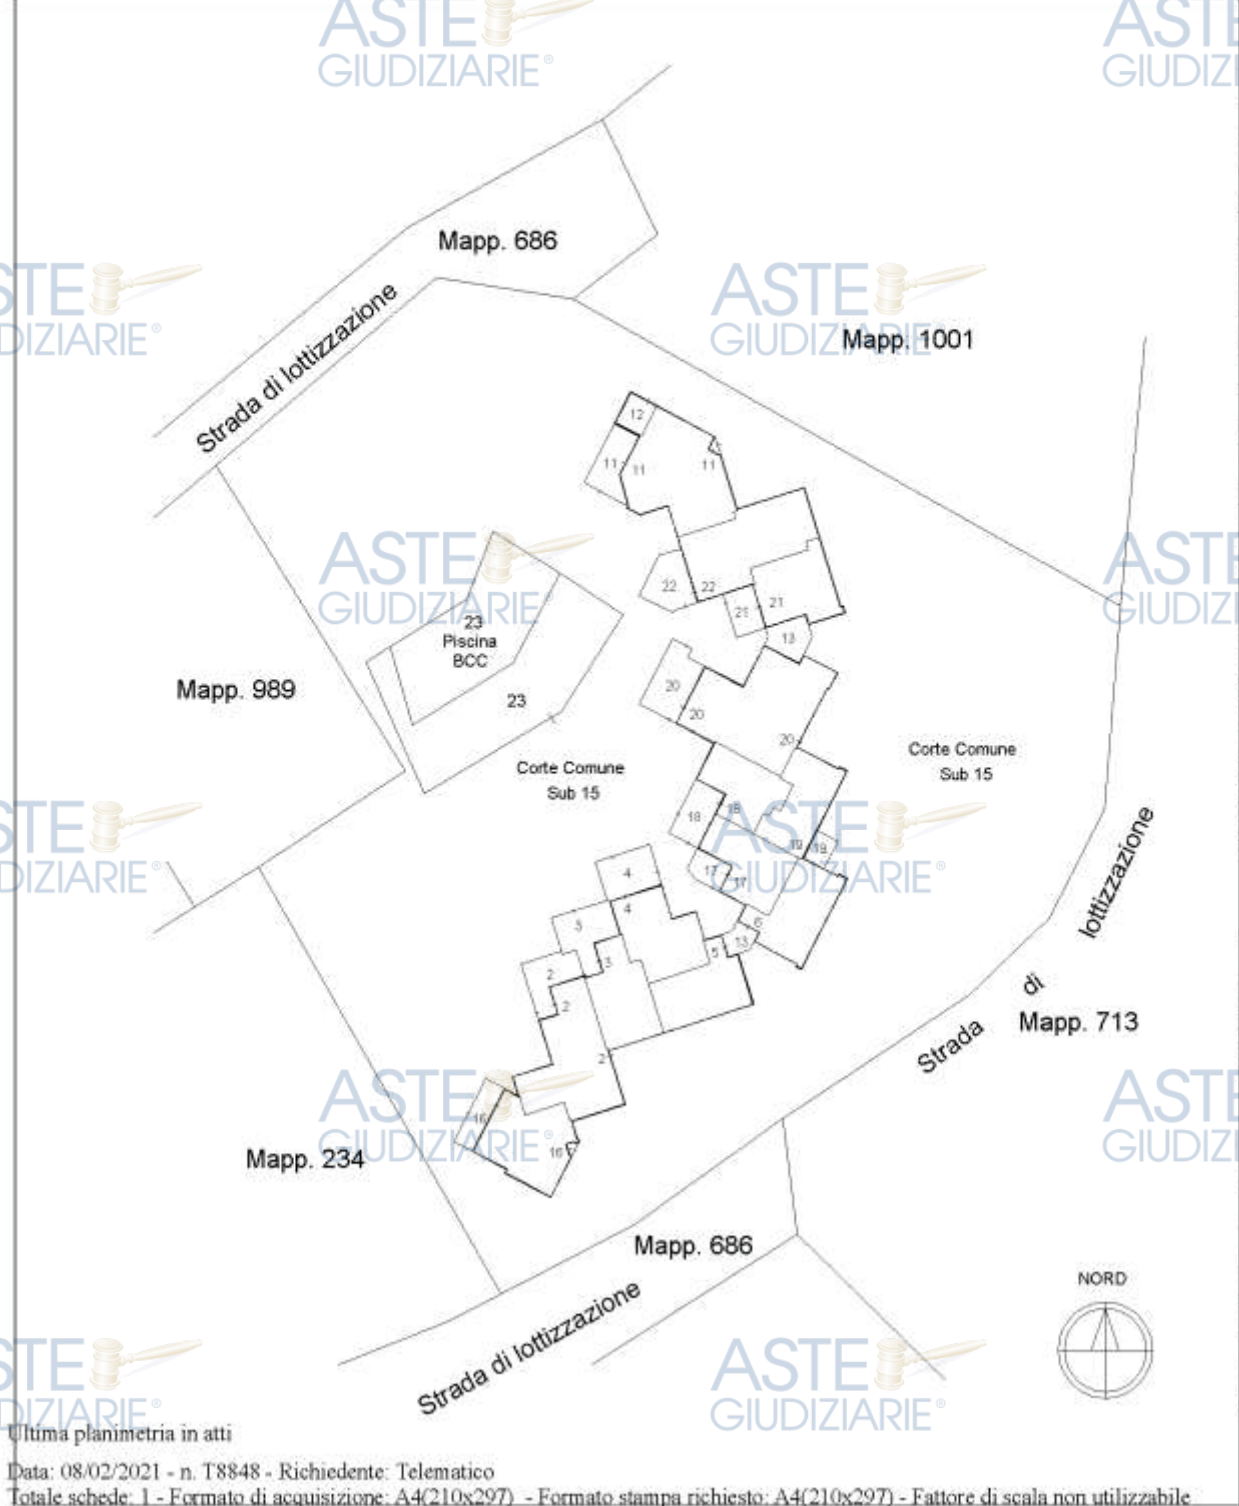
Nuovo elaborato planimetrico degli appartamenti facenti parte del Lotto A30
